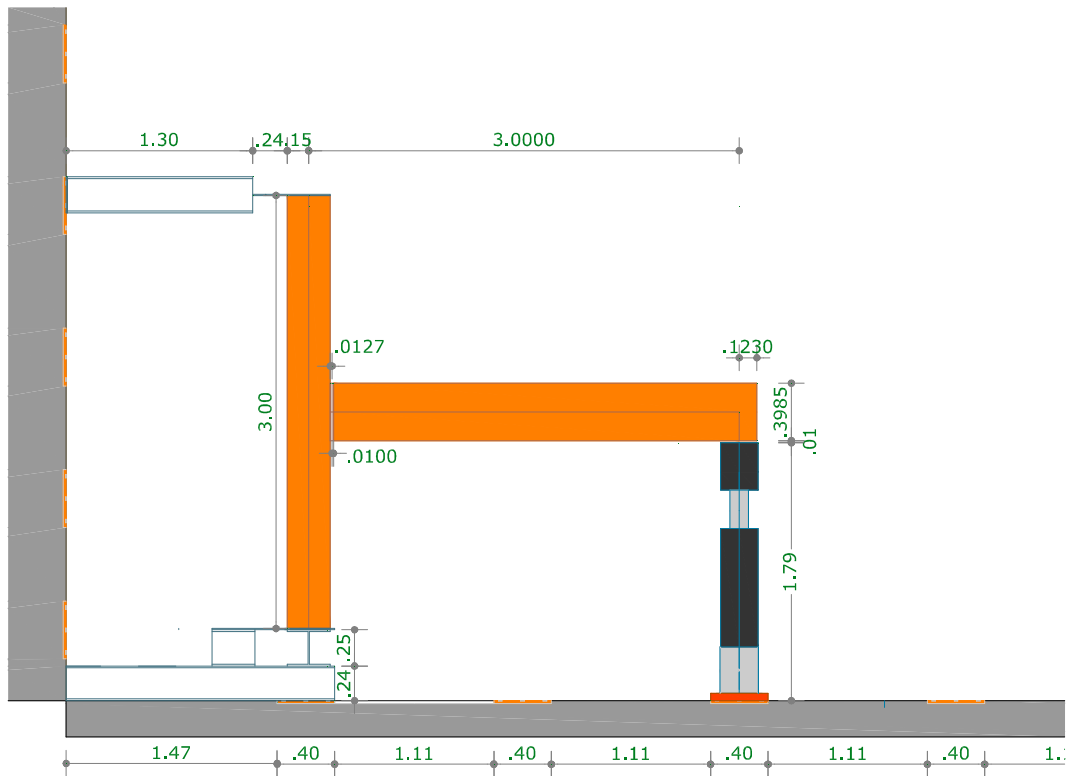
Montaje Specimen Lab. Estructuras - UIS
